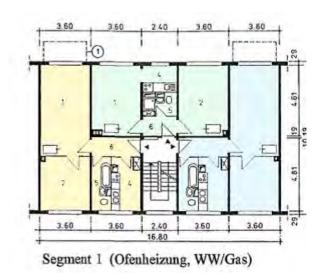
Grundrissbeispiele für Typ IW64 4 Etagen
